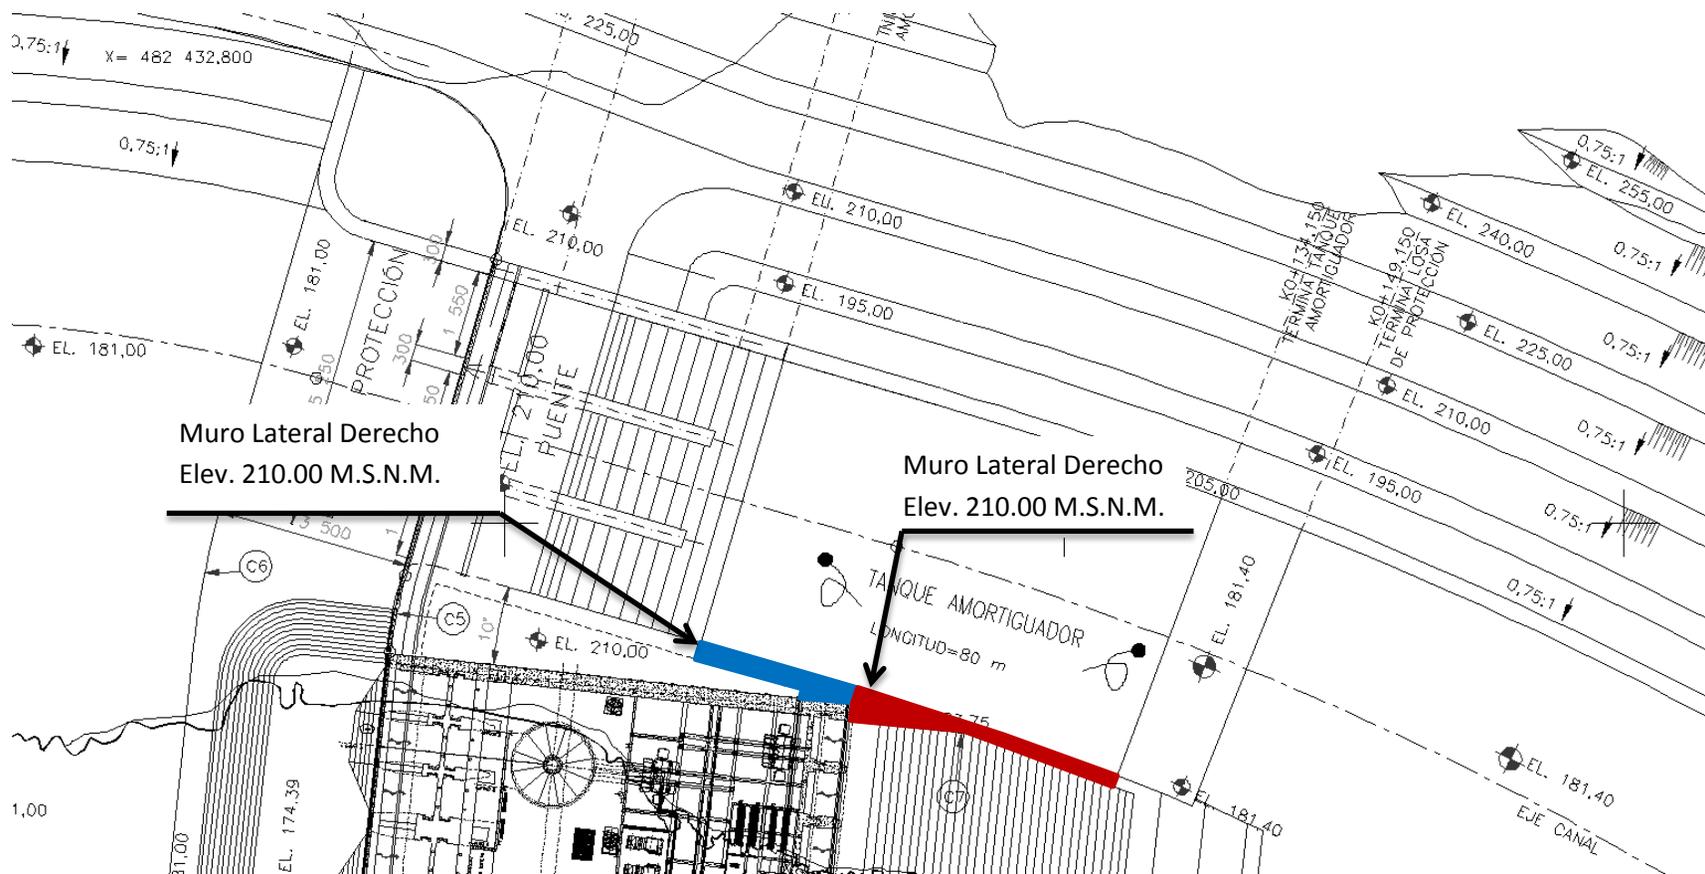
Etapas de construcción de muro lateral derecho y planta
